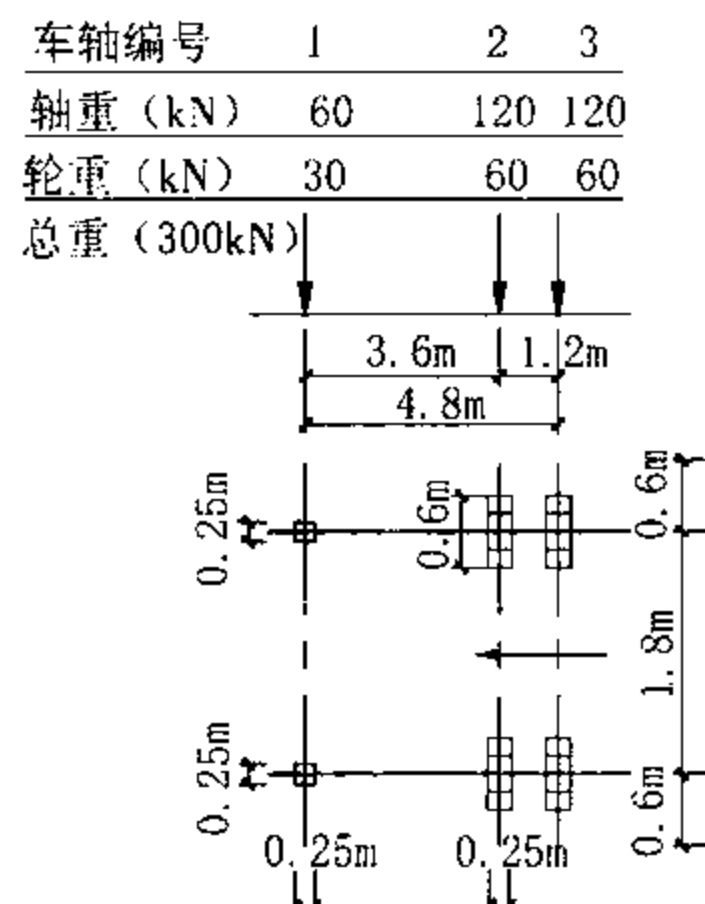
城 - B 级标准车辆纵向和平面布置
